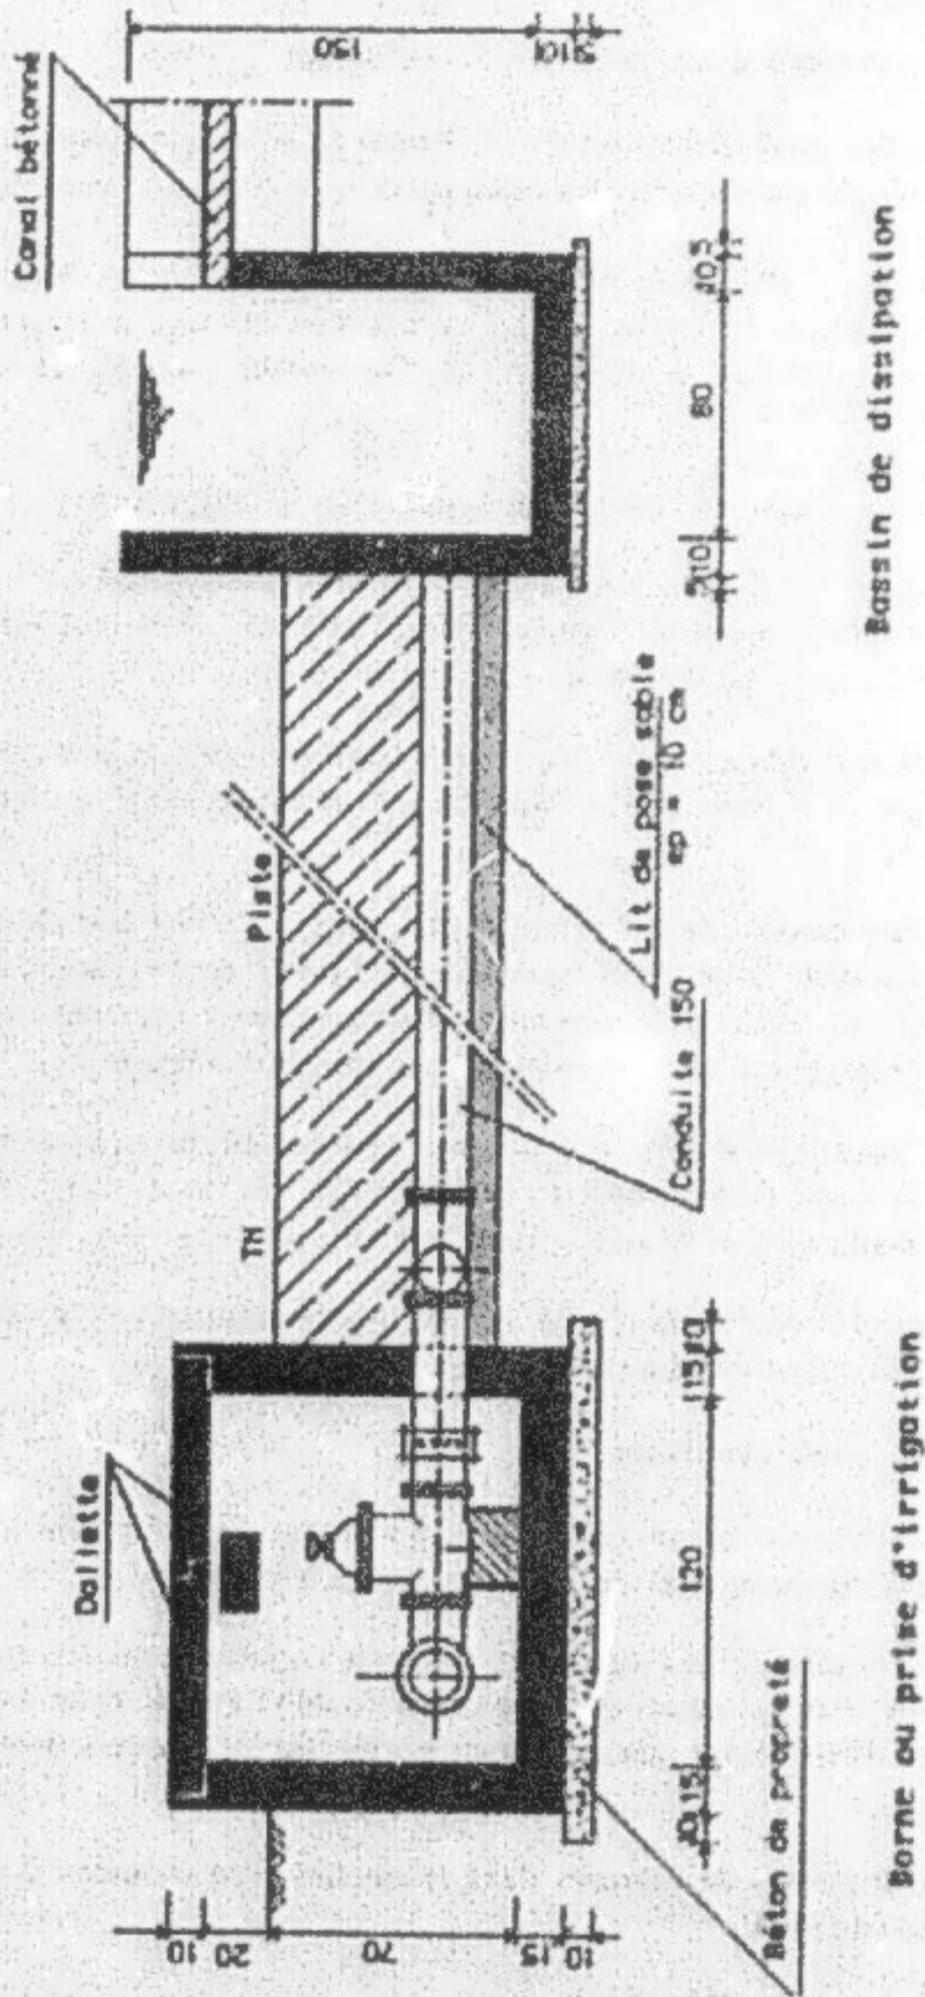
Ouvrage de raccordement d'une borne d'irrigation à un canal bétonné
